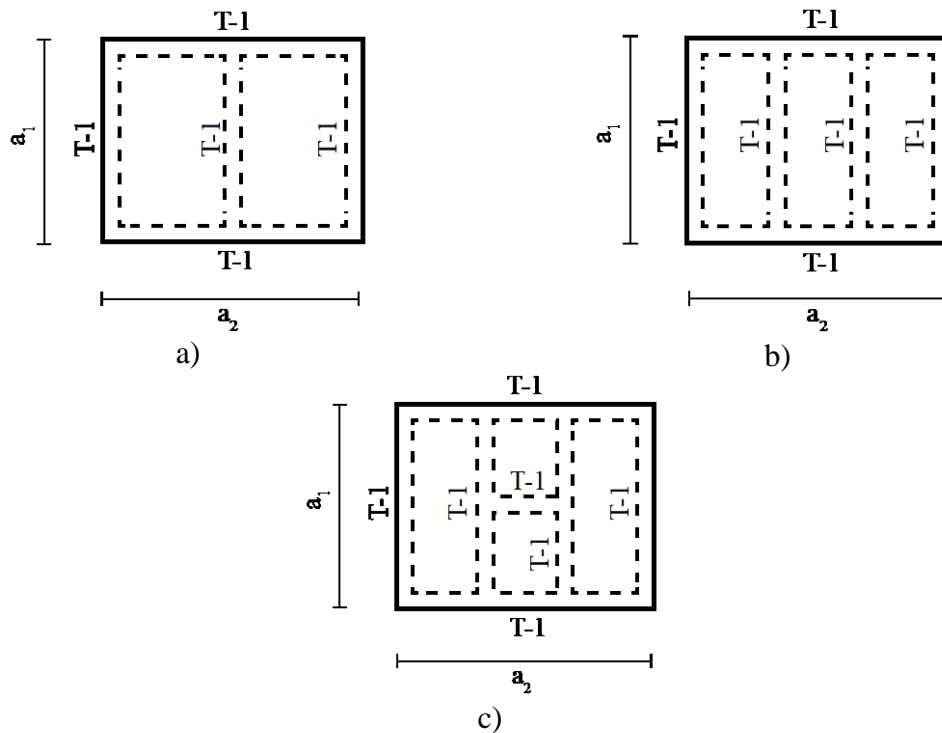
Vigas secundarias en losa de concreto reforzado cuyas configuraciones son a: a) centro del claro, b) tercios del claro y c) con viga terciaria
